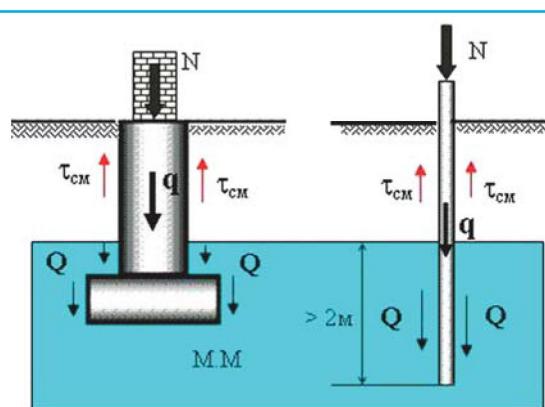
Расчетная схема устойчивости отдельно стоящих и свайных фундаментов в вечномерзлом слое грунта
